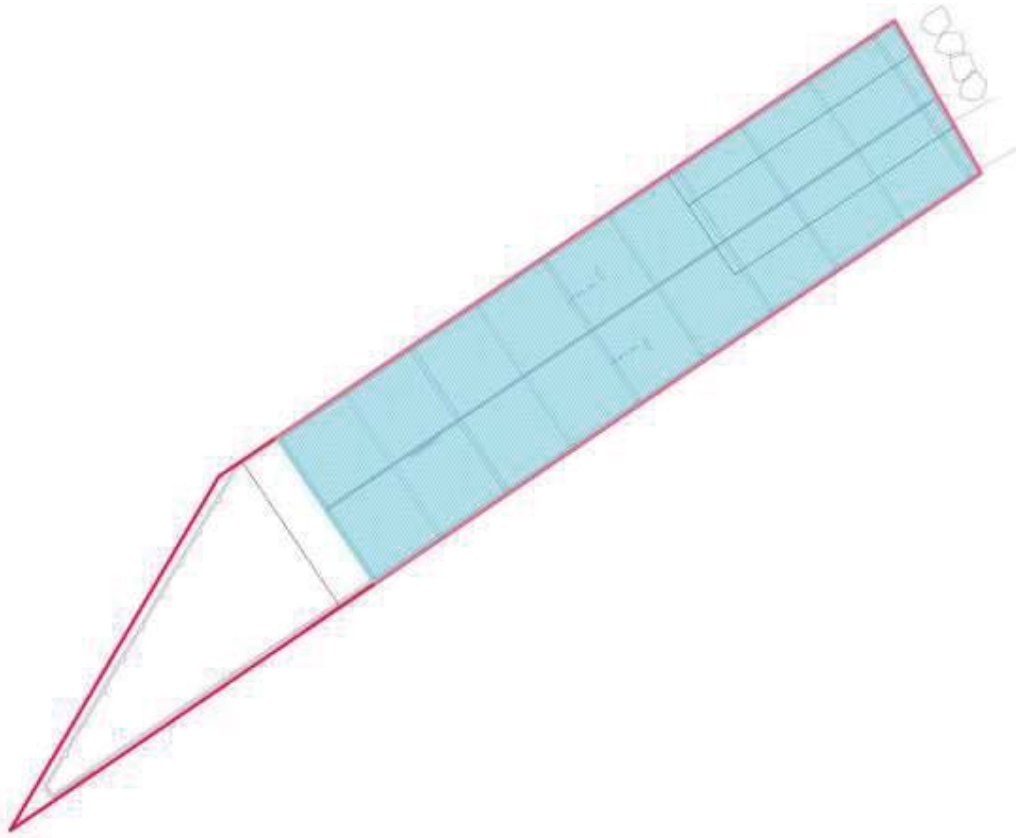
En sombreado azul, las construcciones existentes en el ámbito del Plan Especial
